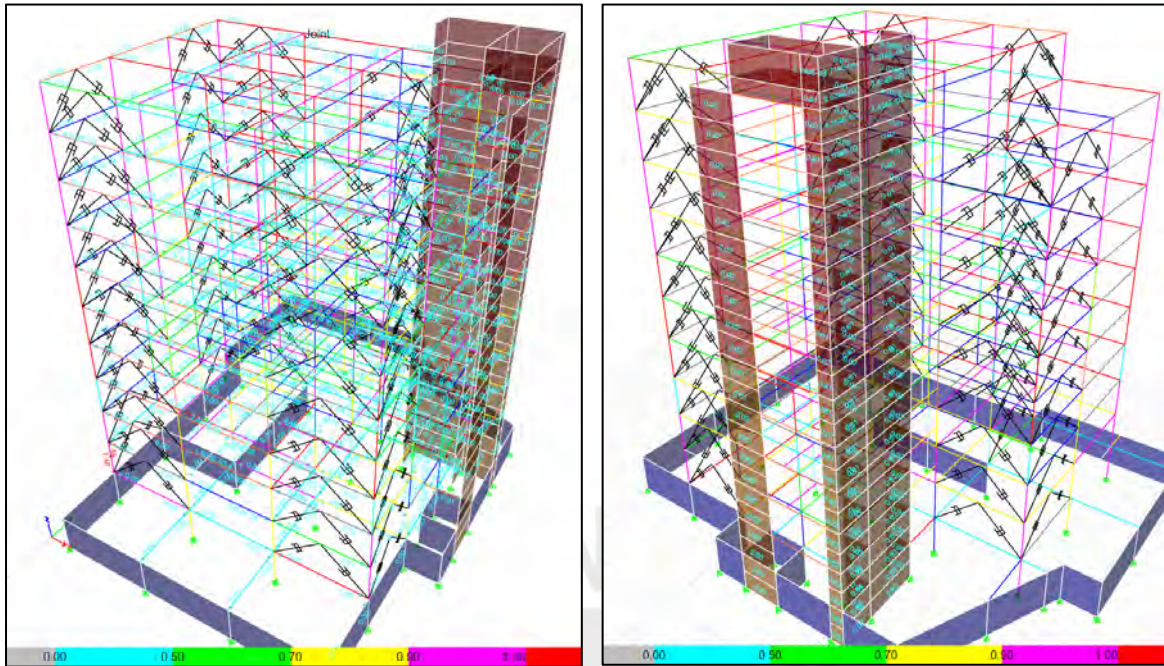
Imágenes de las vigas, columnas y placas para Prevención de Colapso
